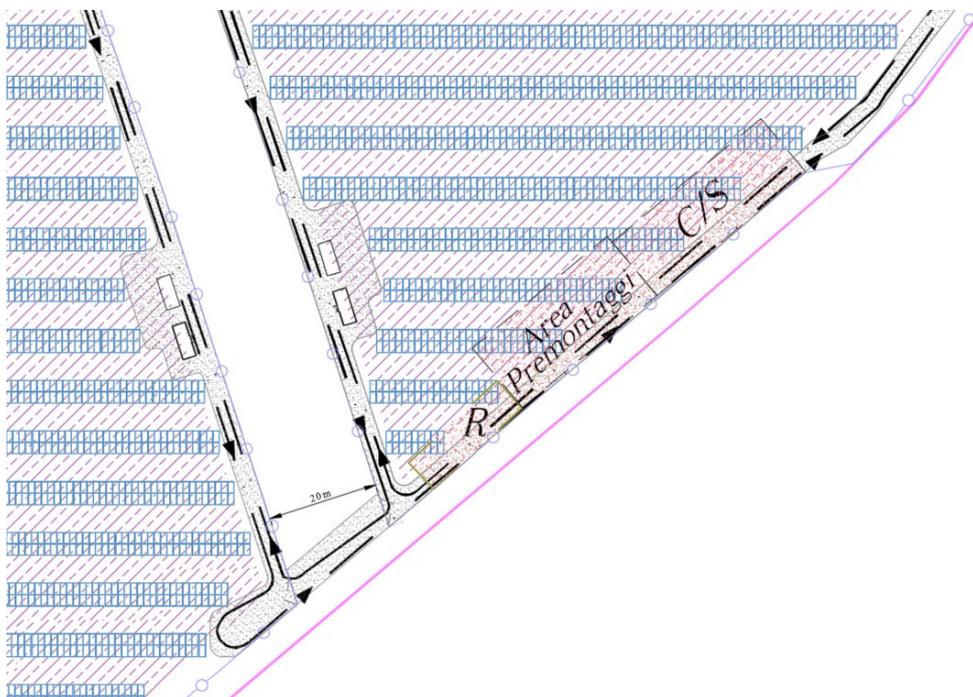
dettaglio area di cantiere “Chions 2”
